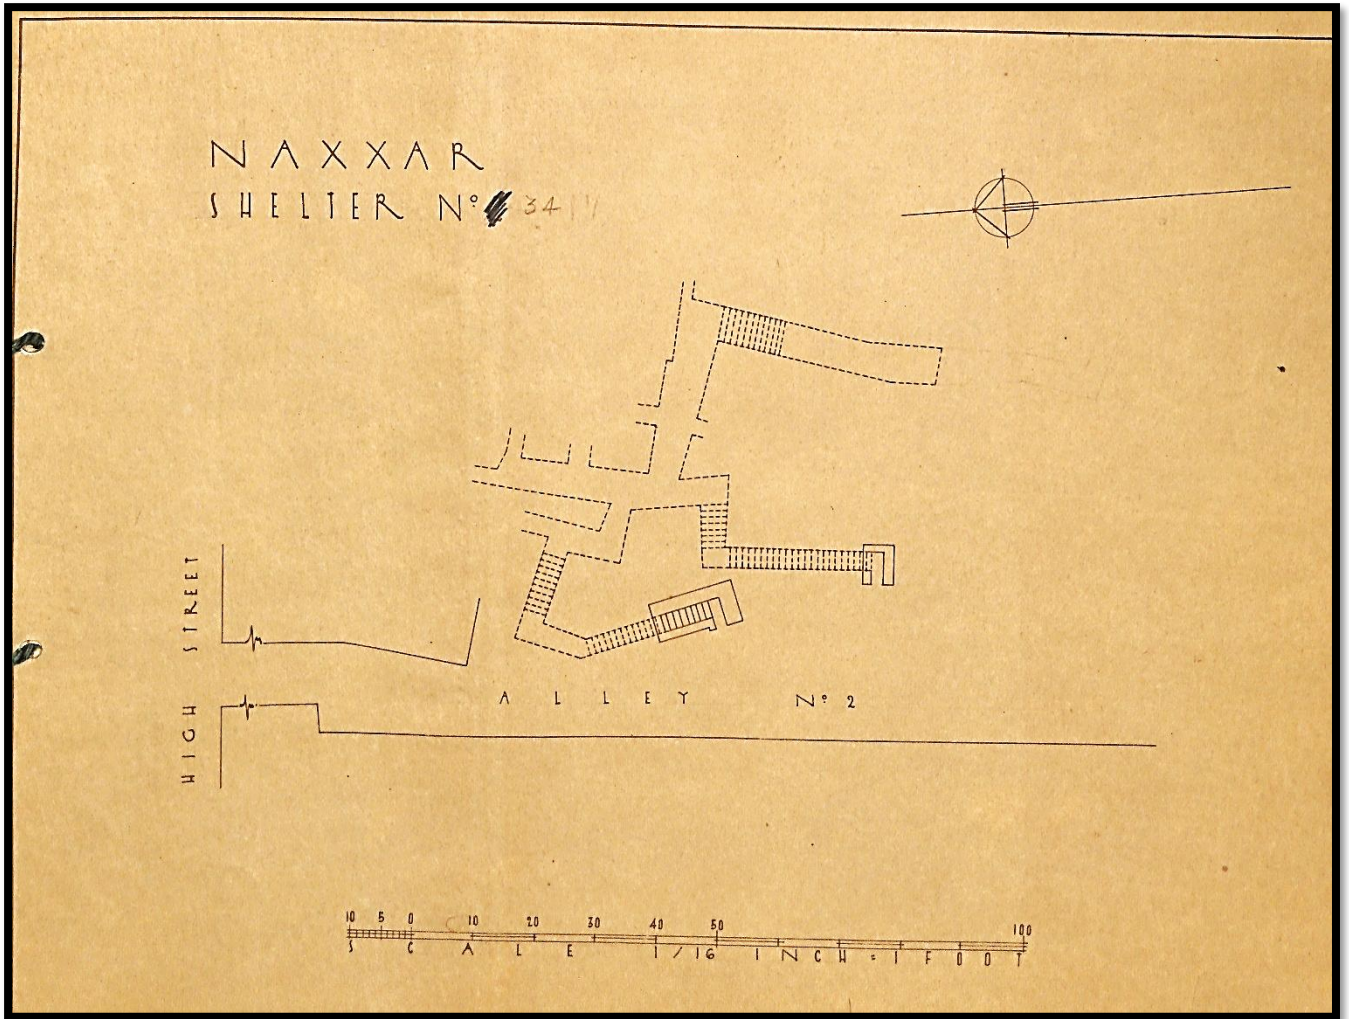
Planta do Abrigo nº34 (14) "High Street – Alley nº2"
